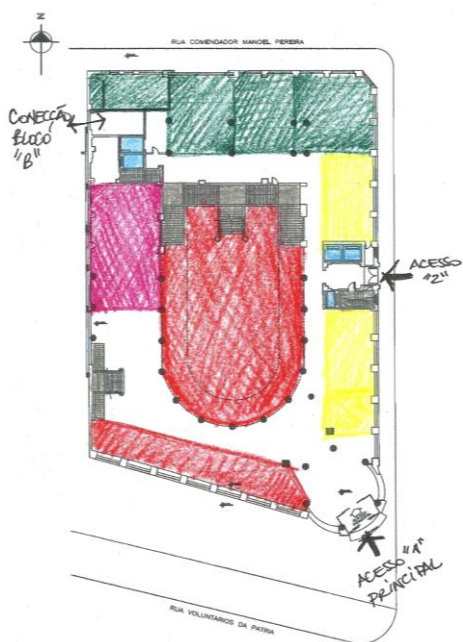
Planta Baixa Térreo - Mapa de Manchas com zonamento da proposta de intervenção.
